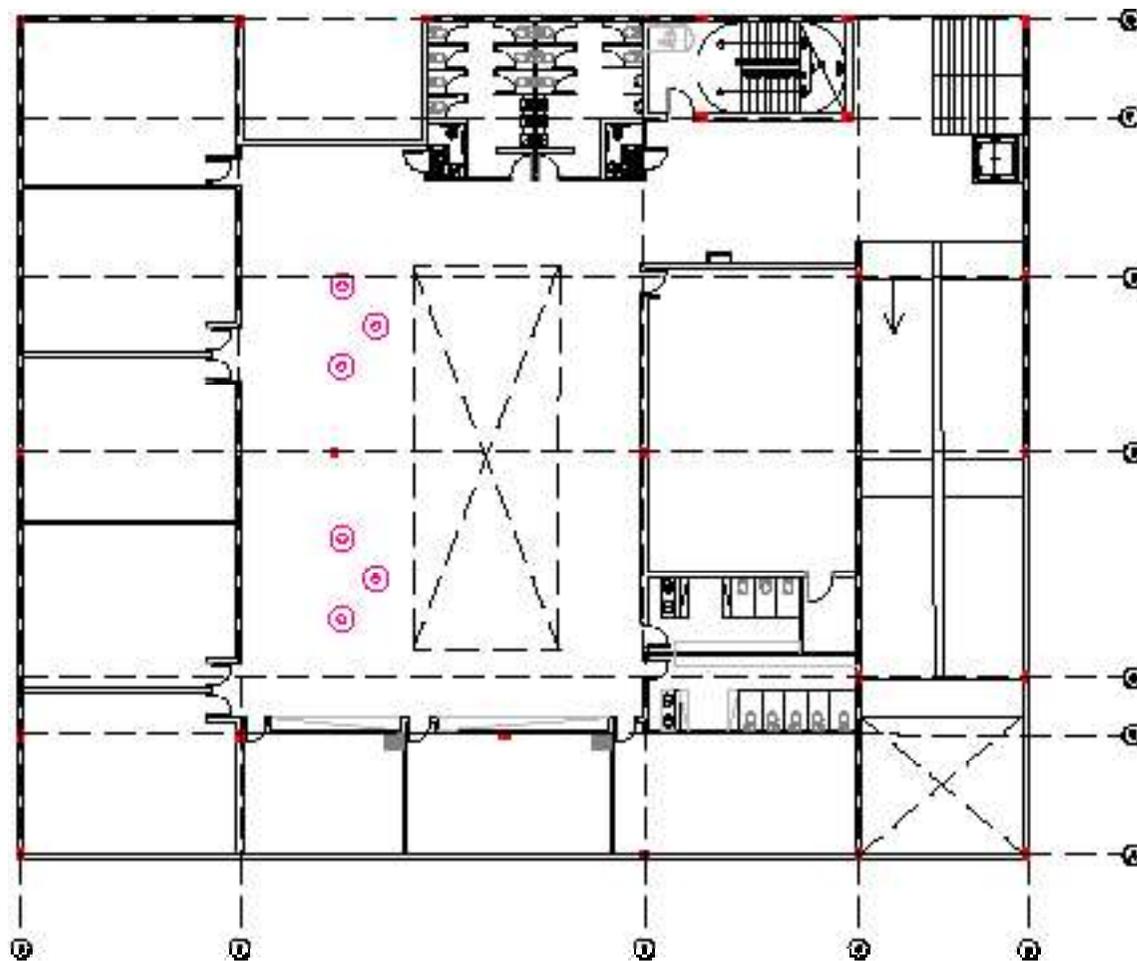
Planta estrutura 1º pavimento - 1:100 - Desenvolvido pela autora
